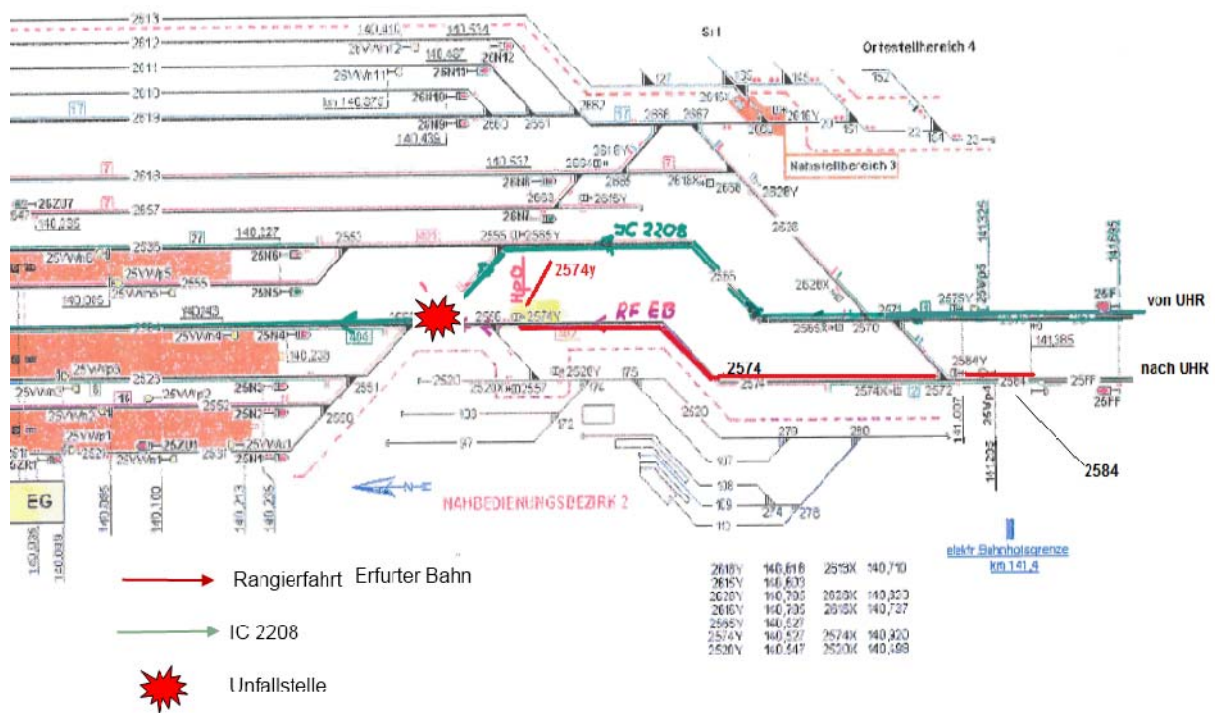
Lageplanausschnitt Bahnhof Saalfeld (Saale)
